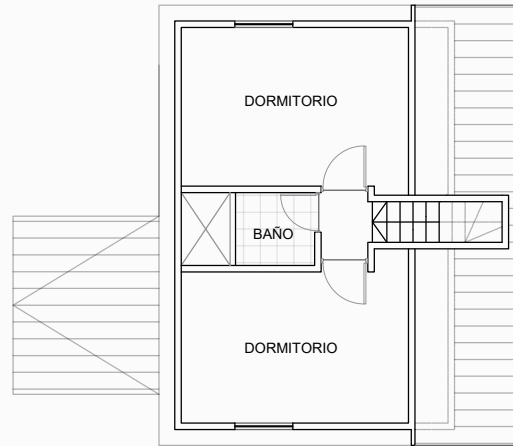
Vivienda original “Tipo B”. Fuente: elaboración propia, 2018.
